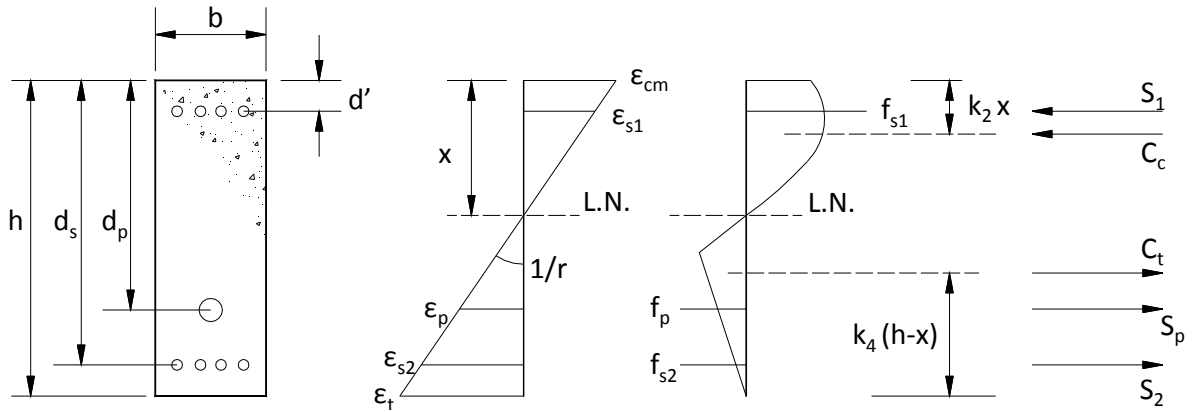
Distribuição de tensões e deformações na seção transversal da viga
